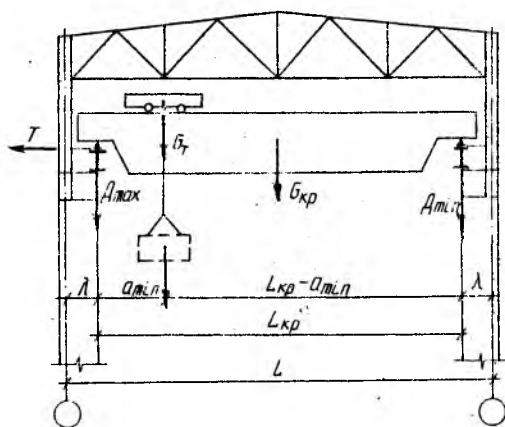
Схема нагружения колонн ПРЗ крановой нагрузкой
